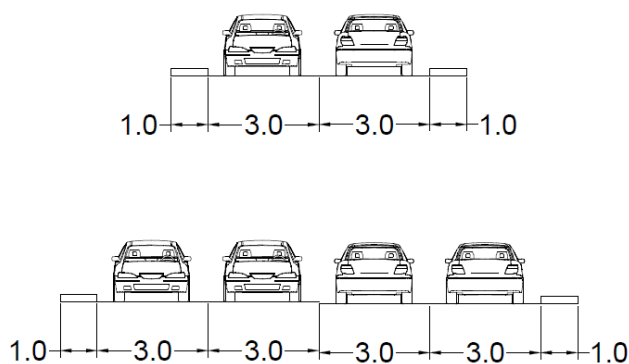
Sección Transversal Av. Pedro Libio Cedeño. (Fuente: Elaboración Propia).
